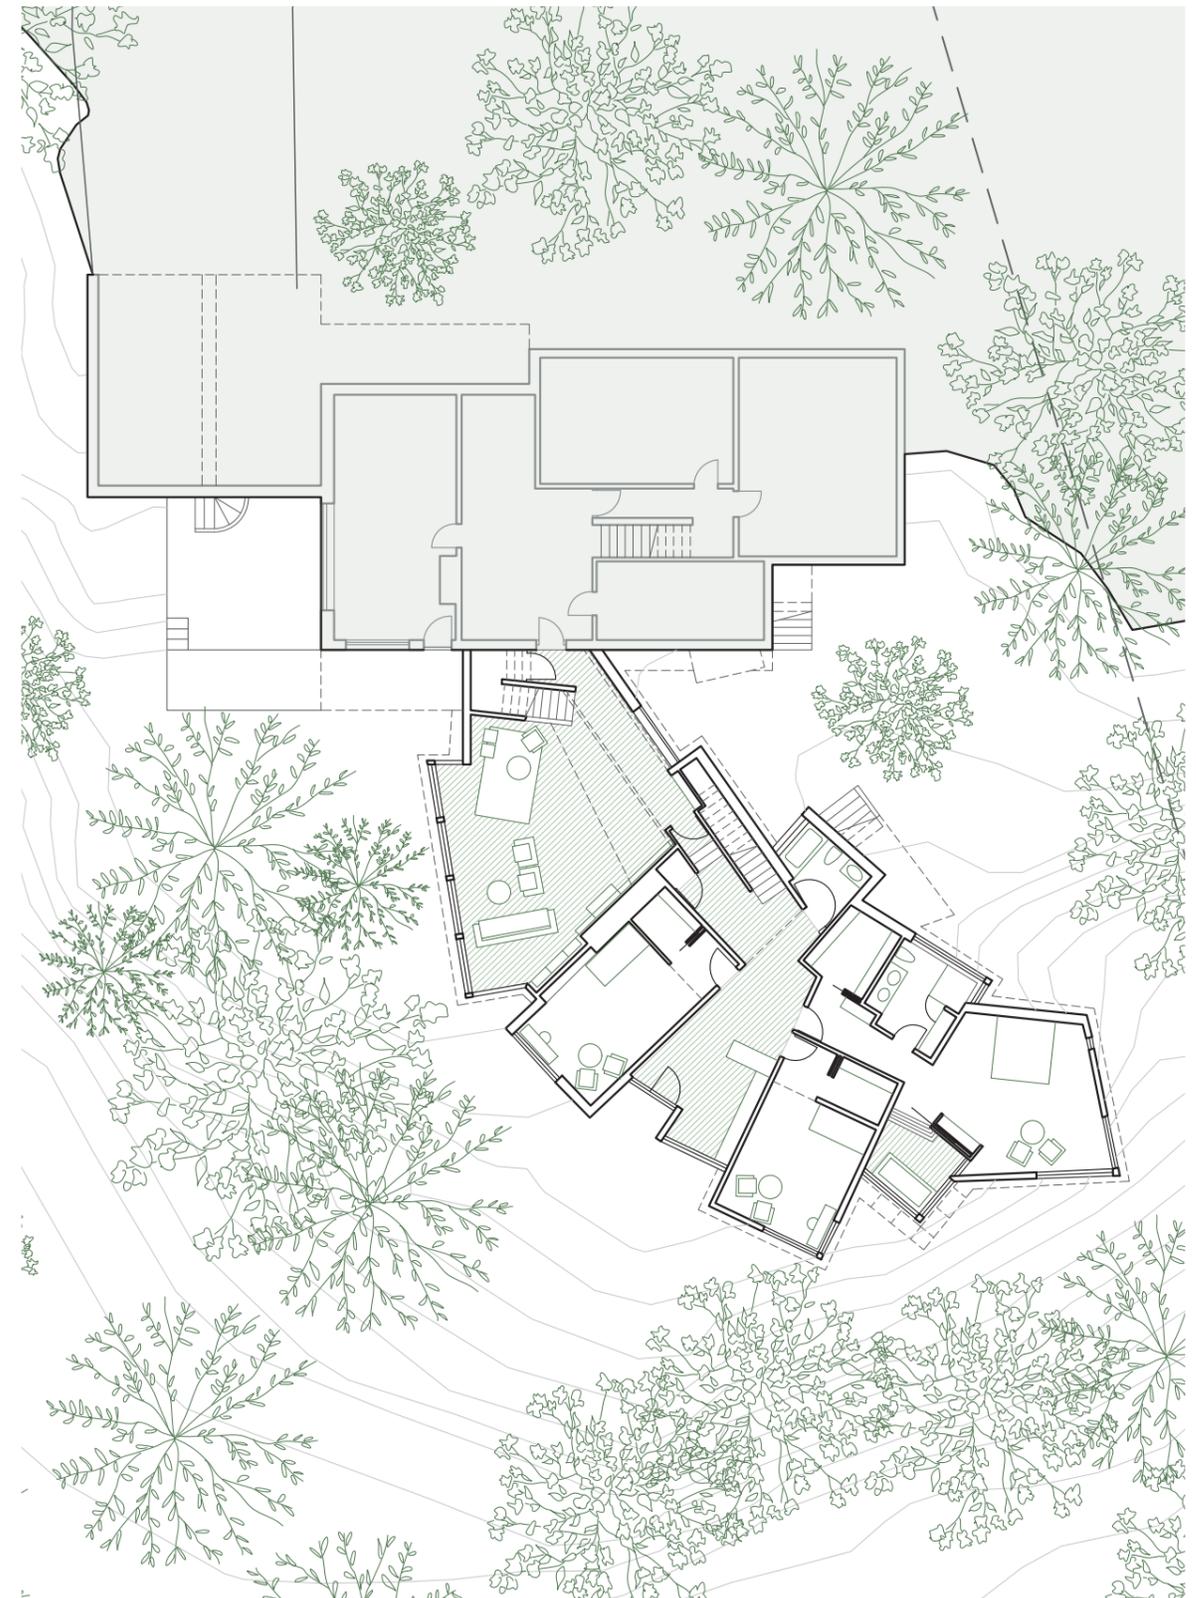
Planta baja, Casa Pollalis. Escala 1:250
